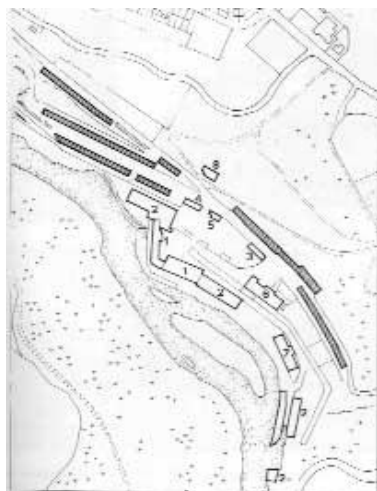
Planta da Vila New Lanark de Robert Owen (1817).
